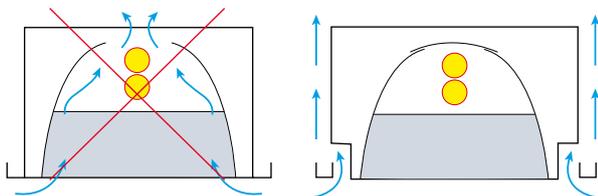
Extraction d'air au travers des luminaires pour lampes T5
